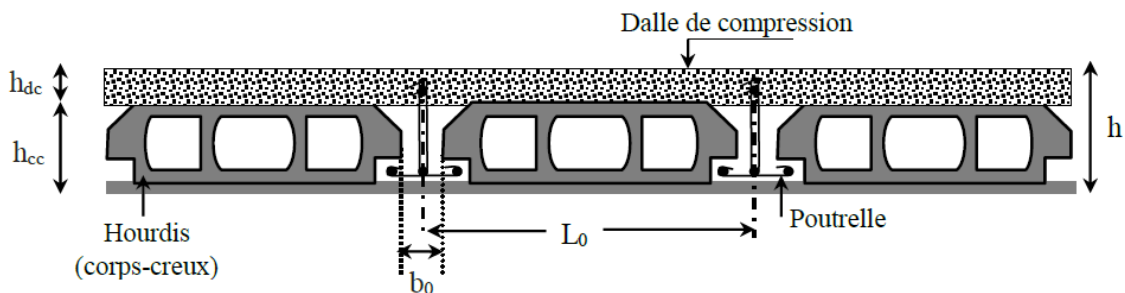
Coupe transversale d'un plancher à corps creux
